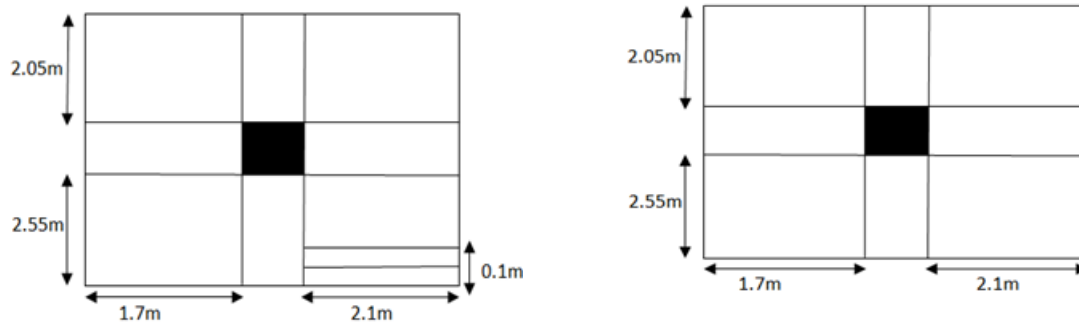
Schéma de poteau la plus sollicité (surface afférente)
